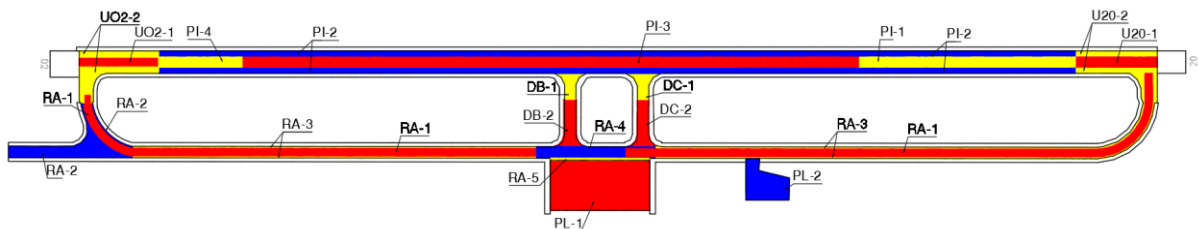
Plano esquemático secciones del aeropuerto Chacalluta.
